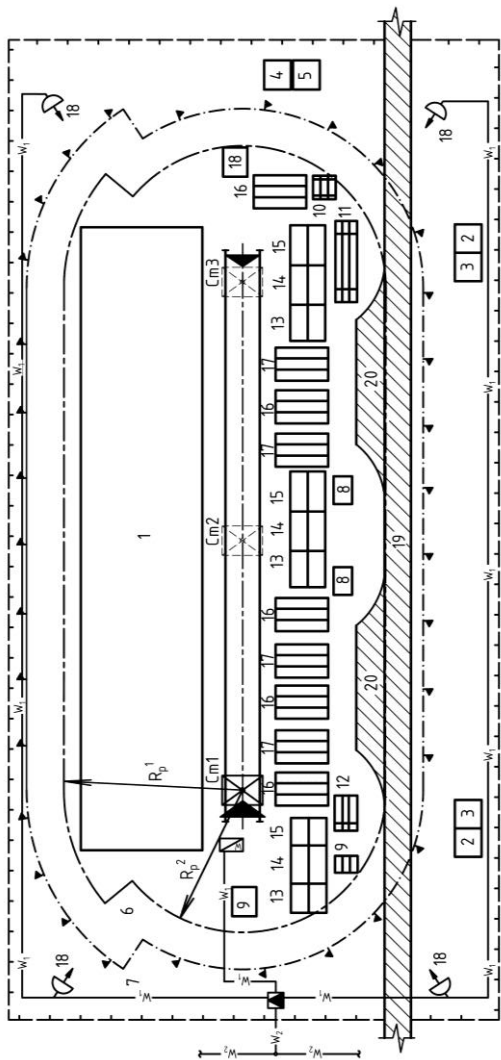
Организация строительной площадки. 1 – строящееся здание; 2 – навес для сантехнических материалов и заготовок; 3 – навес для столярных изделий; 4 – склад для инвентаря и инструмента; 5 – мастерская для специальных работ со складом; 6 – зона крана; 7 – граница опасной зоны; 8 – площадка для приема раствора; 9 – открытая площадка для складирования отдельных элементов; 10–17 – склады сборных элементов; 18 – прожекторы; 19 – автодорога; 20 – разгрузочная площадка; R_p^1 – рабочая зона крана со стороны возводимого здания; R_p^2 – рабочая зона крана со стороны открытого склада
